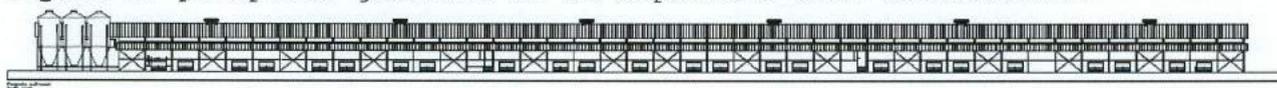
particolare di planimetria di un capannone dell'allevamento.
